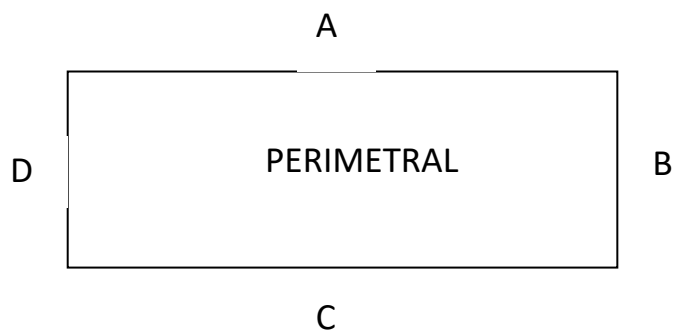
Croquis do corpo de prova do elevado da Perimetral.
